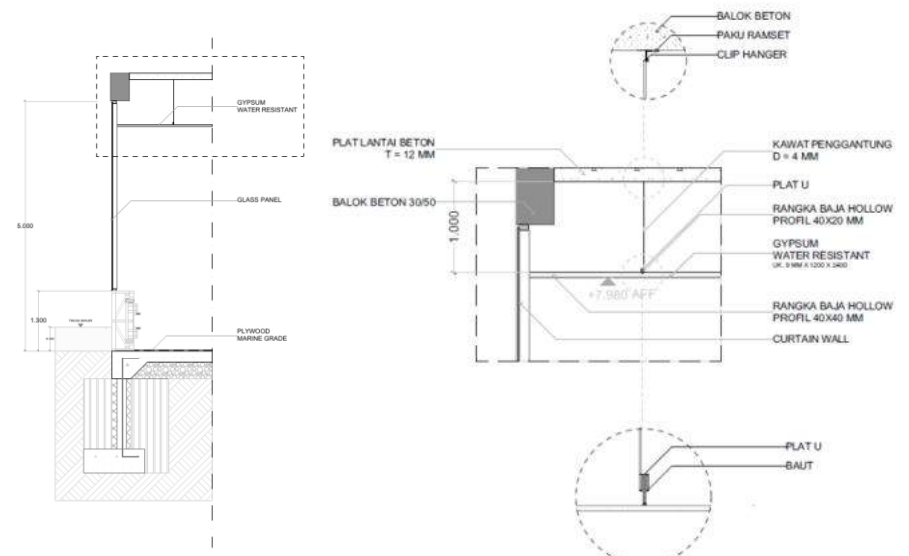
Detail glass panel (Sumber: Penulis, 2021)
